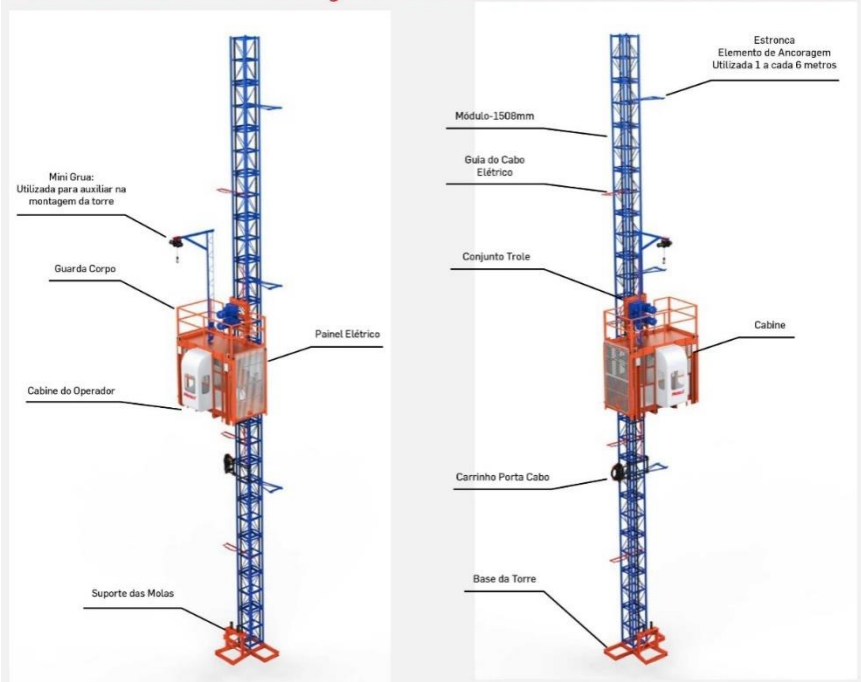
Detalhamento para planejamento da instalação do elevador de cremalheira
